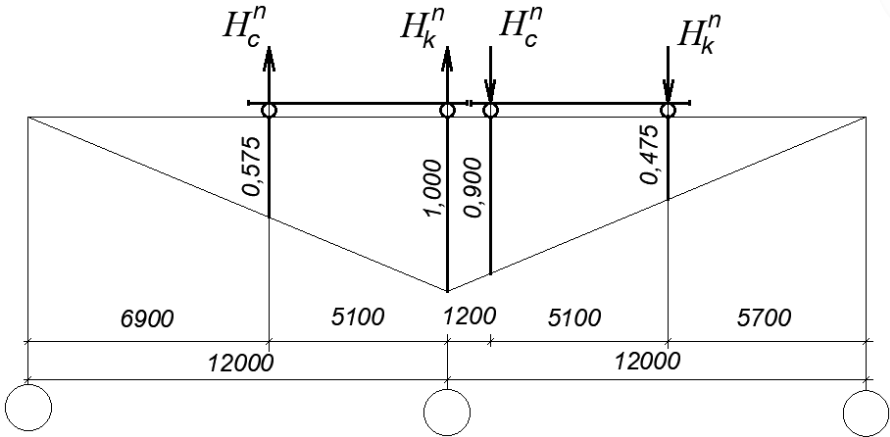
Схема для визначення горизонтальних кранових бічних навантажень від двох зближених кранів на середню опору за другим рекомендованим варіантом для лівої сторони крана
